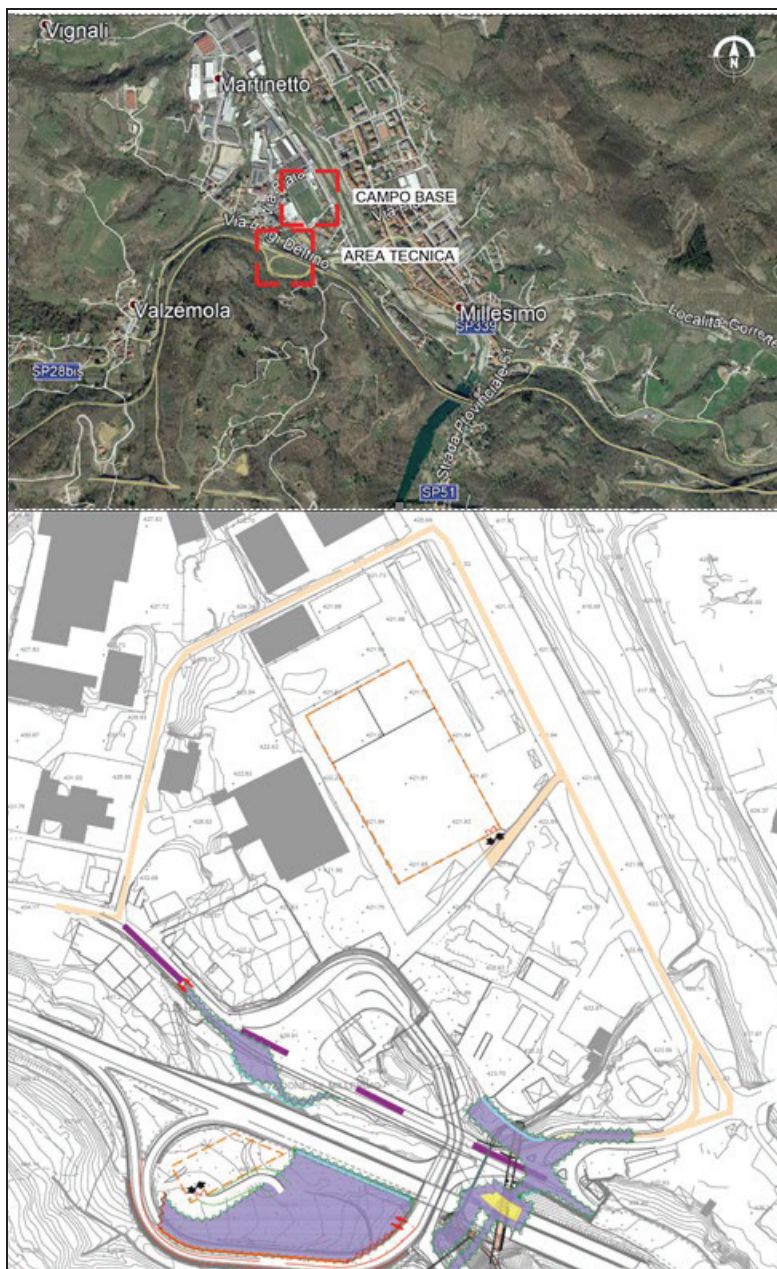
Localizzazione e planimetria generale della cantierizzazione
